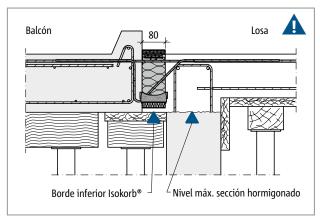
Schöck Isokorb® T tipo K: Balcón íntegramente prefabricado con losa desplazada en altura sobre muro de hormigón armado prefabricado
